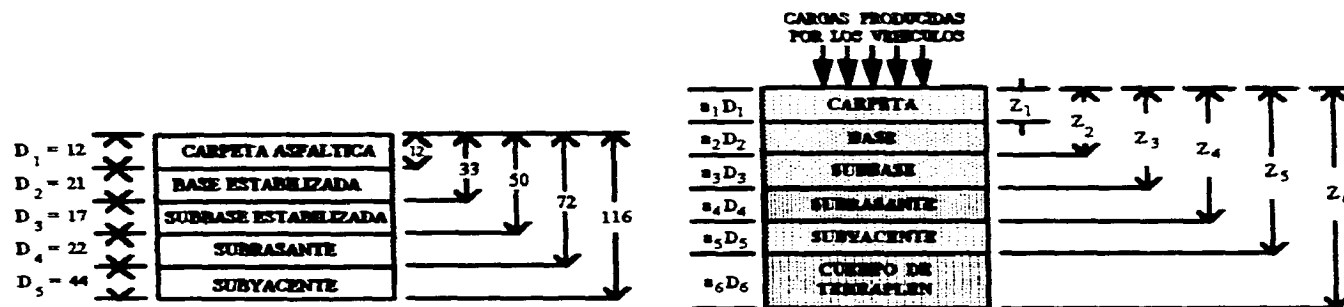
GRAFICA PARA EL DISEÑO ESTRUCTURAL DE CARRETERAS CON PAVIMENTO FLEXIBLE
